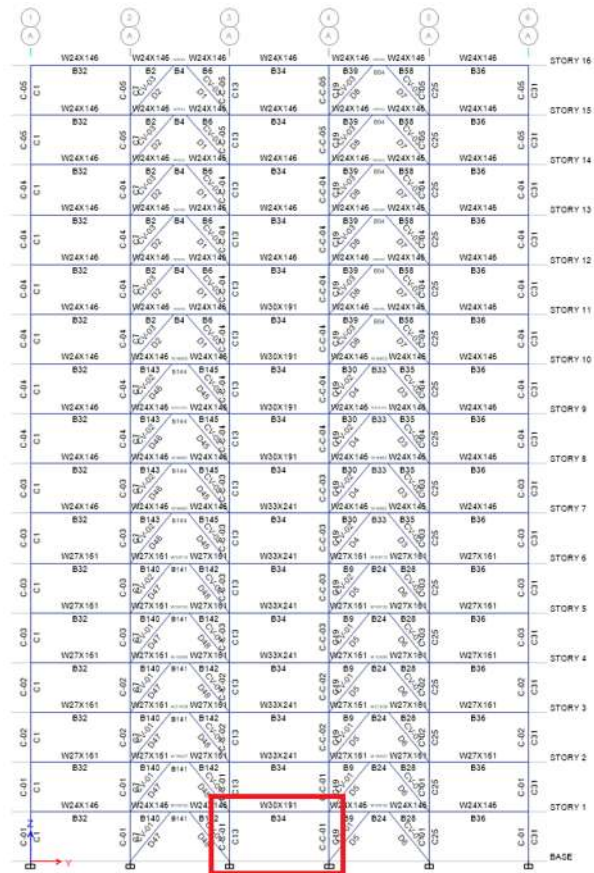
Corte A del edificio de 16 Niveles para el cálculo de LAP en columnas (ETABS; 2013)
